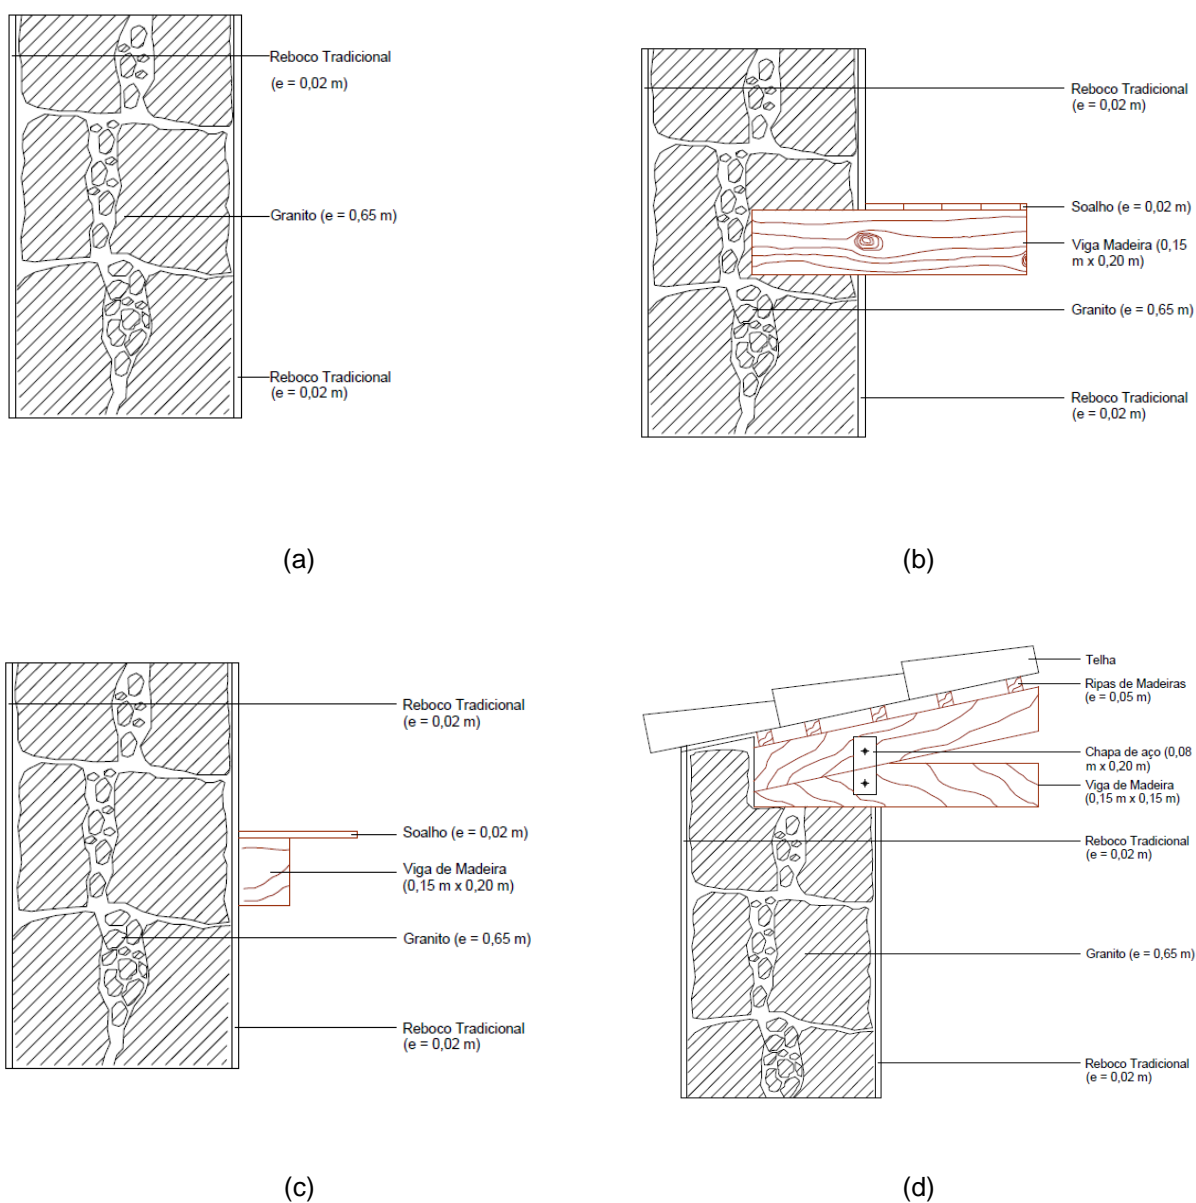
Soluções padrão de uma parede tradicional em alvenaria de pedra: (a) zona corrente; (b) ligação das paredes principais aos pavimentos; (c) ligação das paredes secundárias aos pavimentos; (d) ligação das coberturas às paredes
